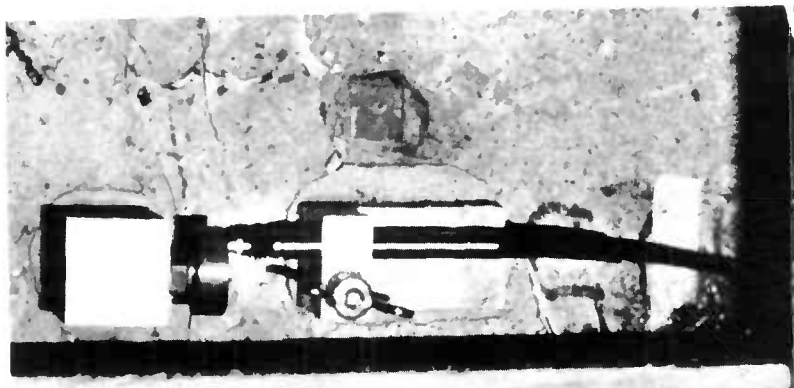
Capteur électrique et repères de contrôles (sur une poutre en béton).
